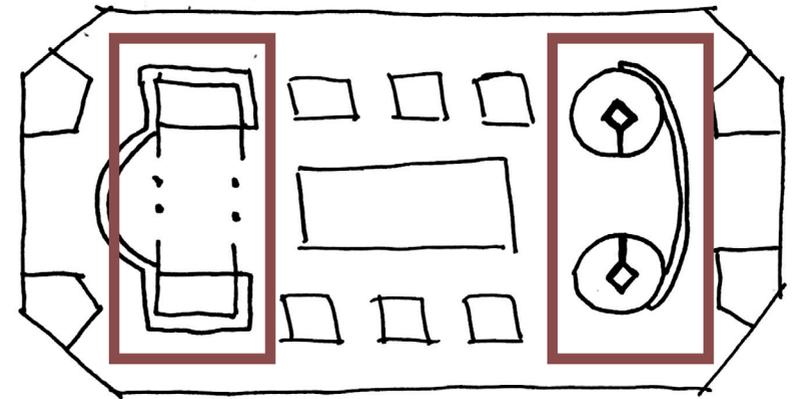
Esquema de la zona intermedia de las dos entradas principales del Mercado de Colón
